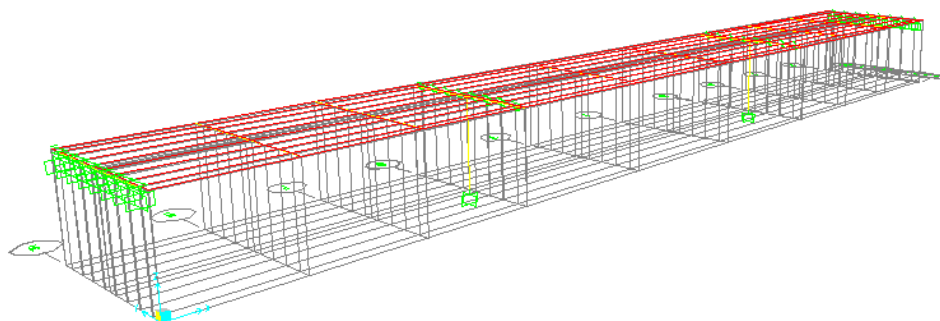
Modelo analítico del Puente Copándaro II con pilas tipo muro (elementos tipo “FRAME”), 3D (SAP2000).
